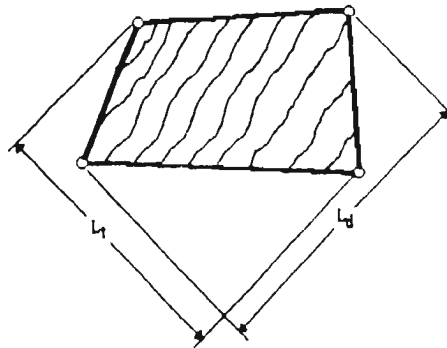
Bandas de fisuramiento y de aplastamiento.
